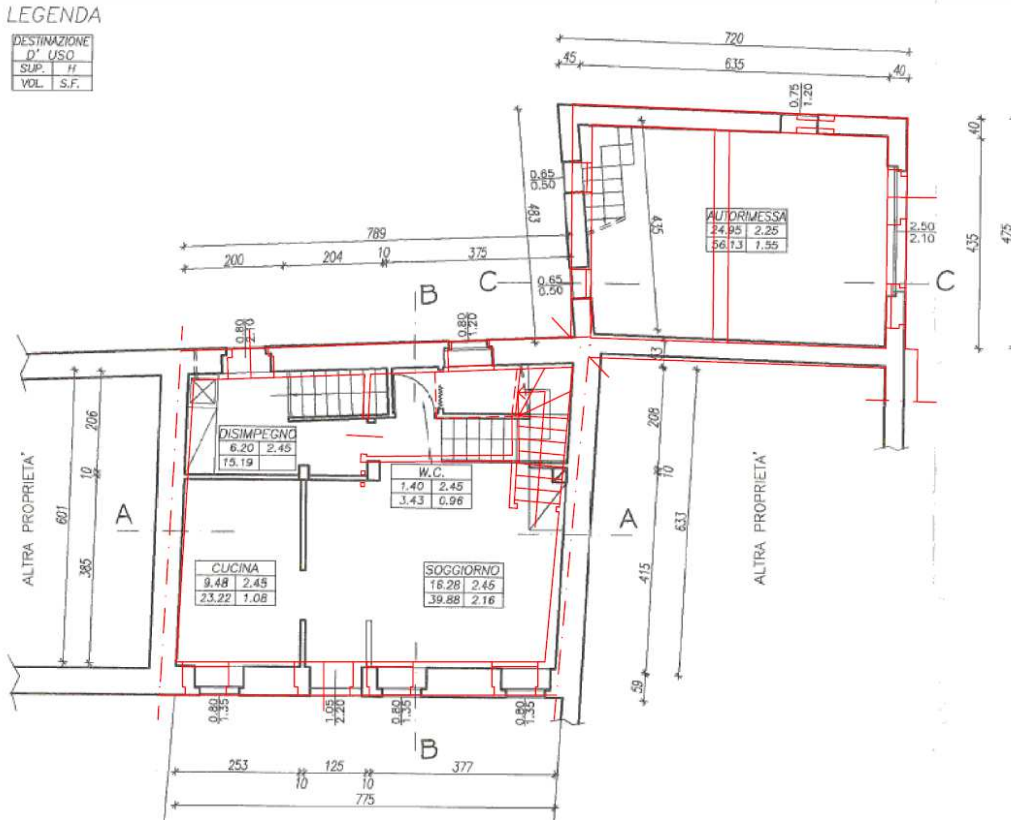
Comparazione stato attuale – stato approvato – piano terra.
